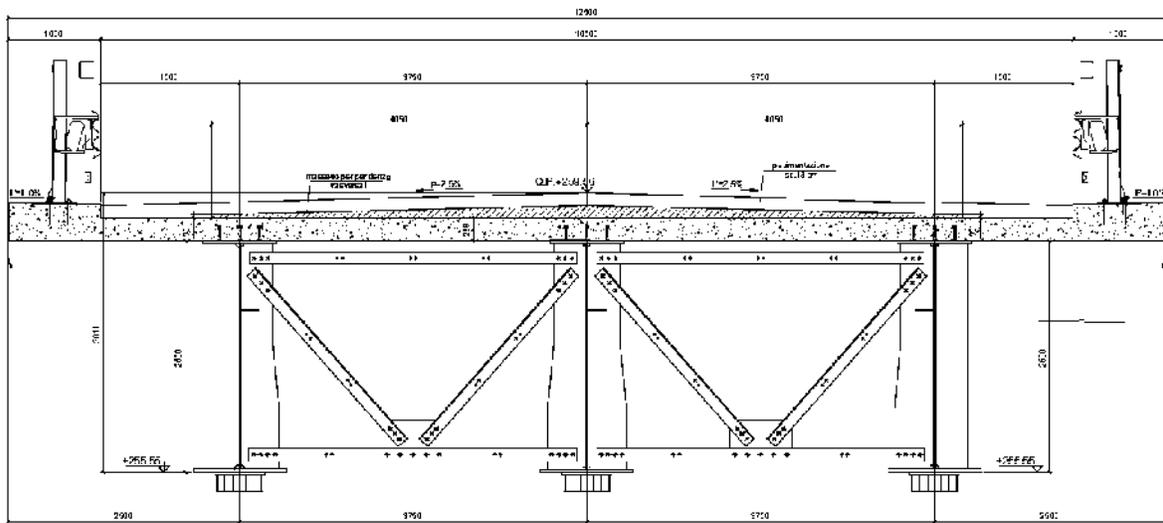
Ponte su Faidana - OP3-038 - Planimetria progetto
